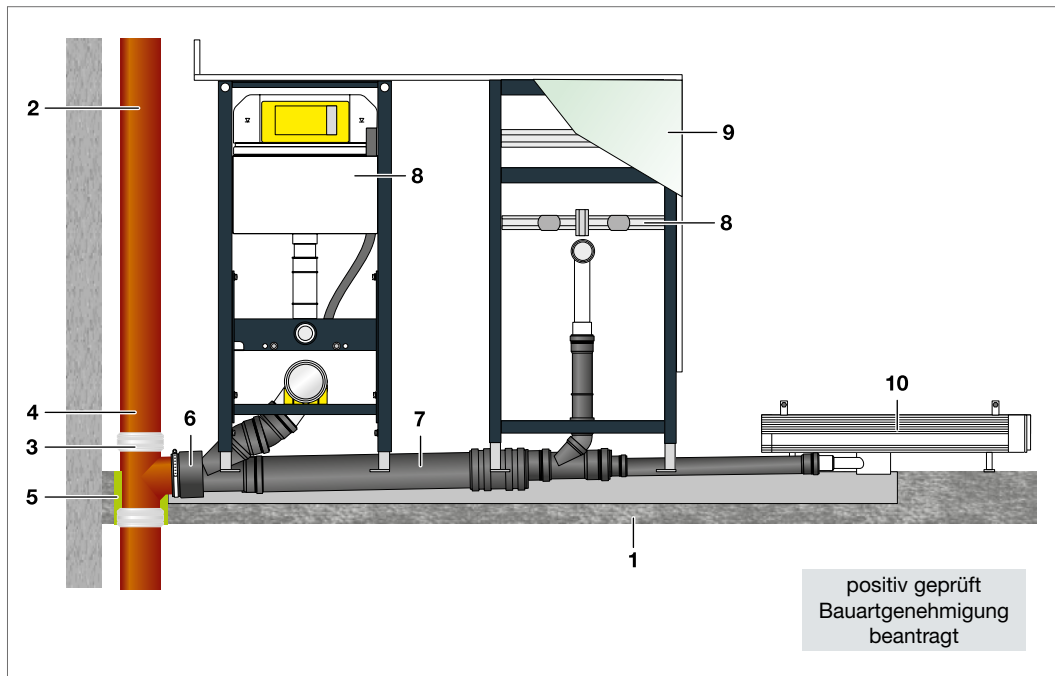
Beispiel einer Badezimmermontage mit Prevista Dry
